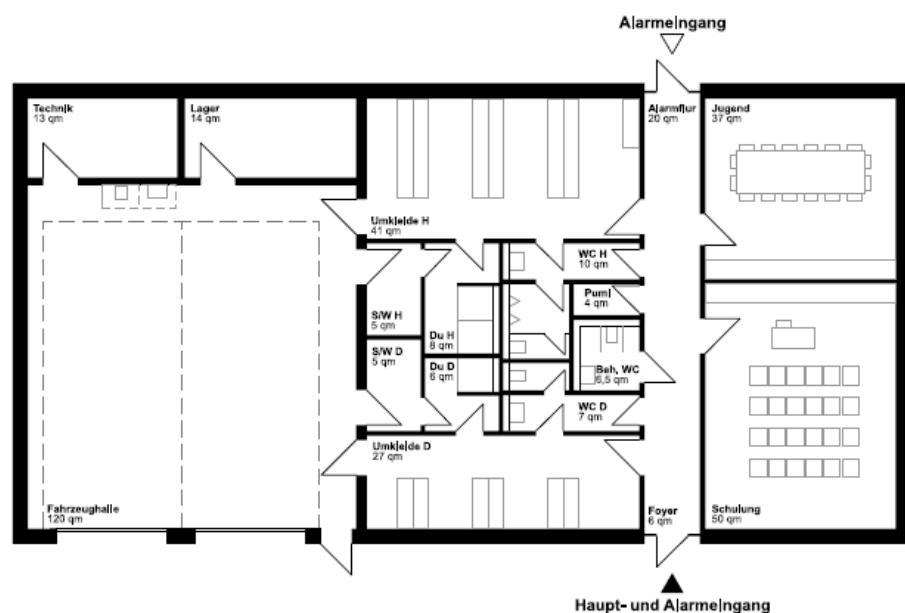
Grundrissplan, flächenbereinigt
